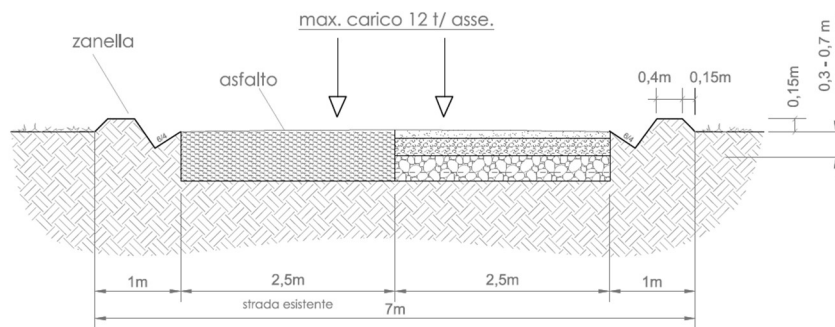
Sezione stradale tipo nel caso di allargamento della sede stradale esistente
